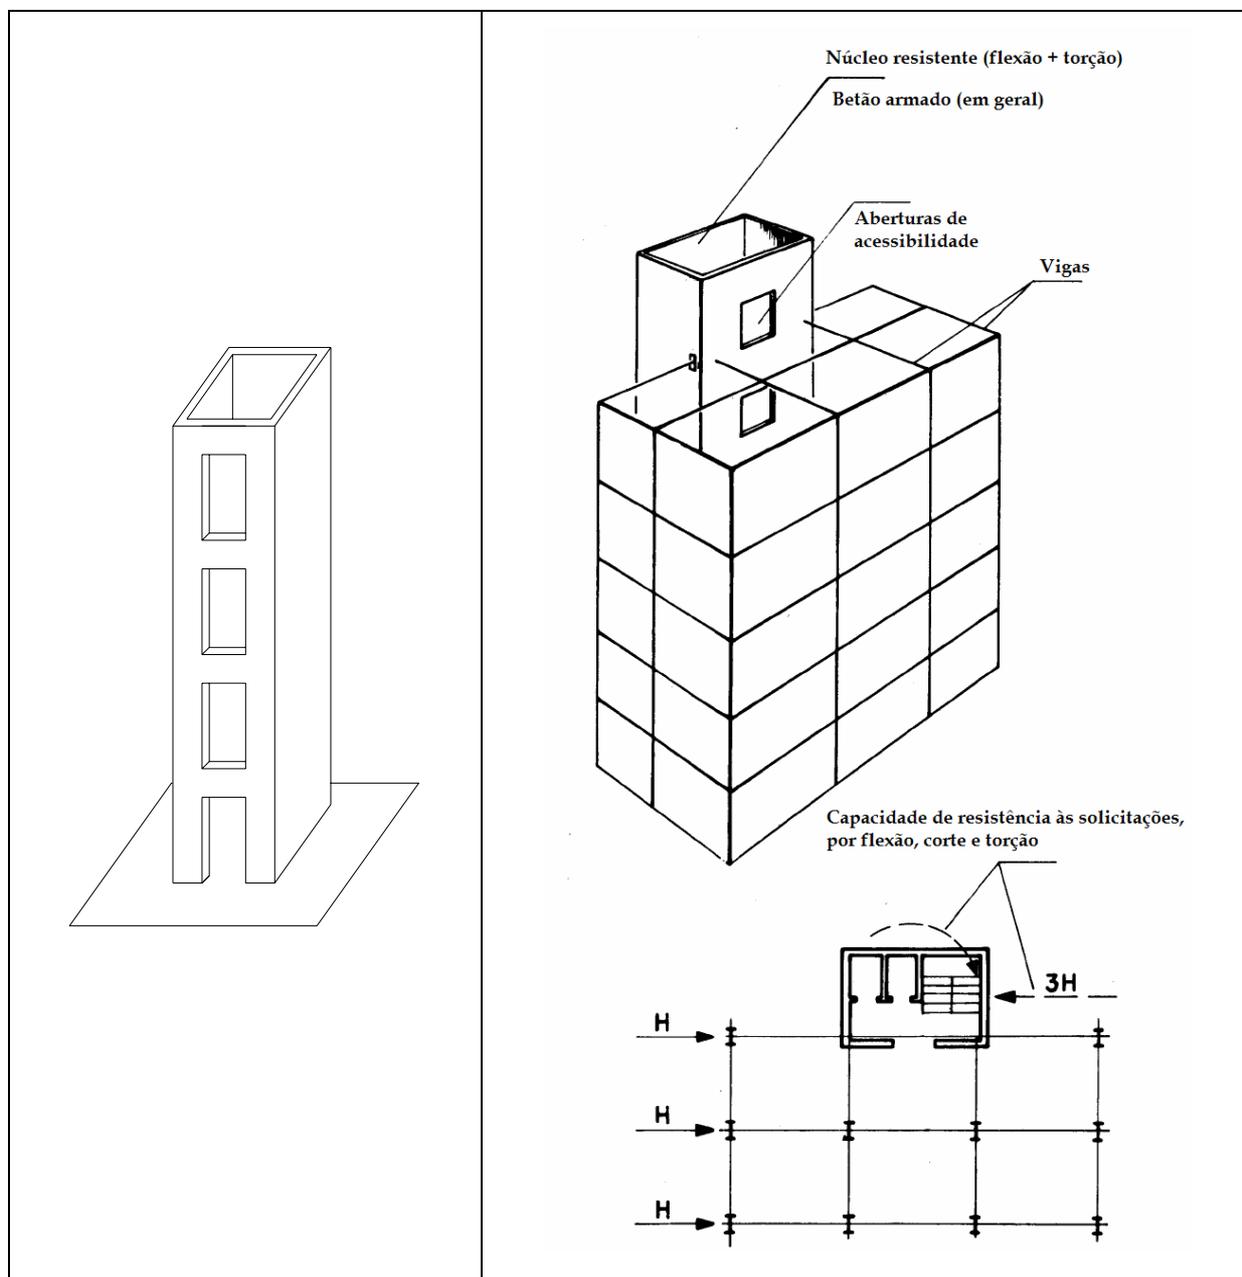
Núcleo estrutural (normalmente caixa de escadas ou elevadores) [22]
